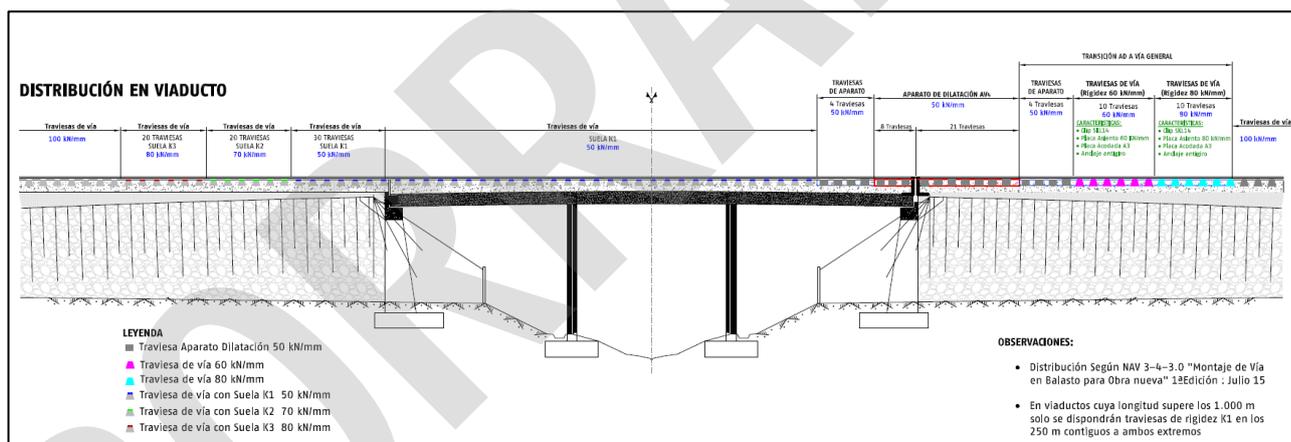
Esquema distribución de traviesas con suela en viaducto con aparato de dilatación en estribo
